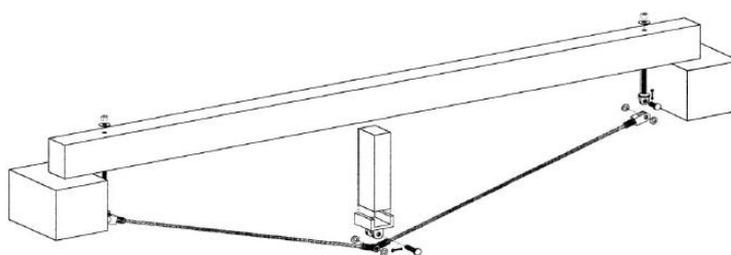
Reforço de viga por aplicação de pré-esforço com tirantes metálicos (Mariani, 2004)
